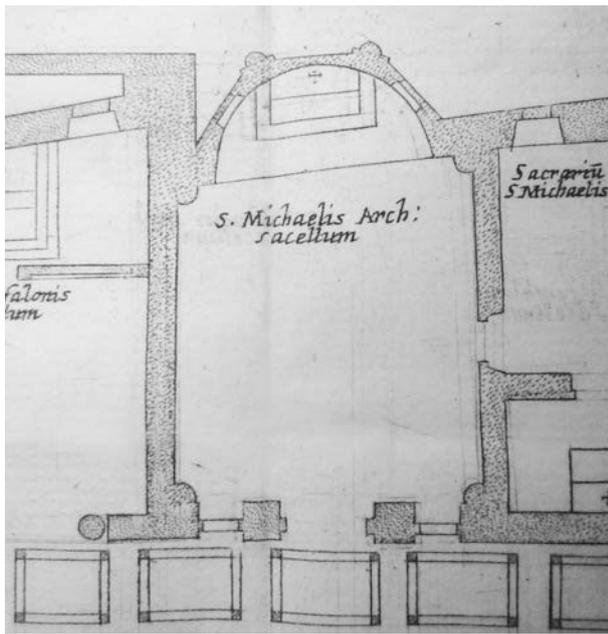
Rom, S. Maria Maggiore, Grundriss der Michaelskapelle, Detail (nach De Angelis 1621)
